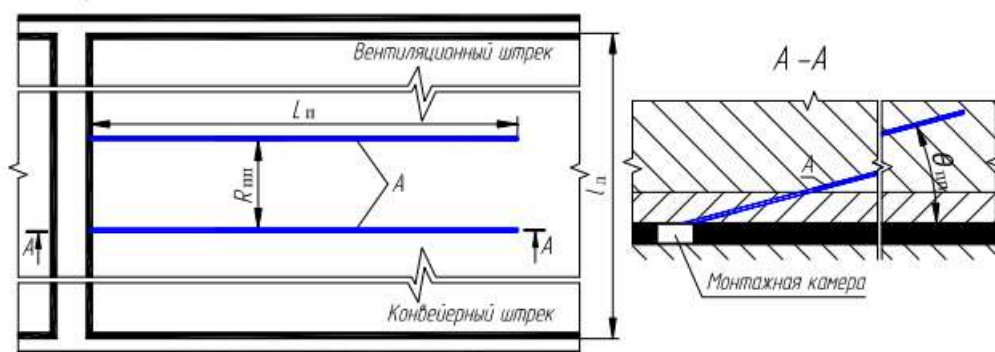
Схема разупрочнения основной кровли при первичной посадке
